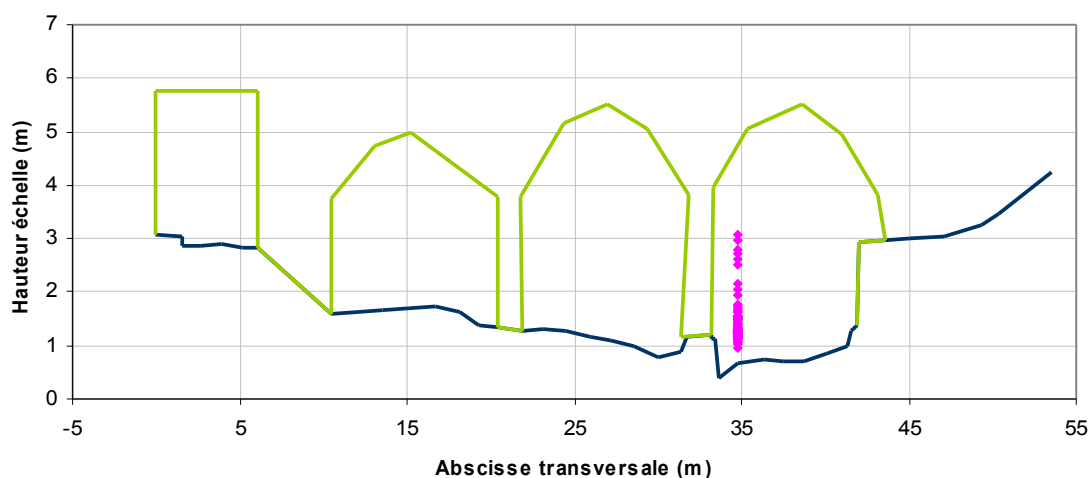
Section en travers au droit du limnimètre (en rose, les hauteurs correspondant aux jaugages disponibles et en vert les arches du pont SNCF)
